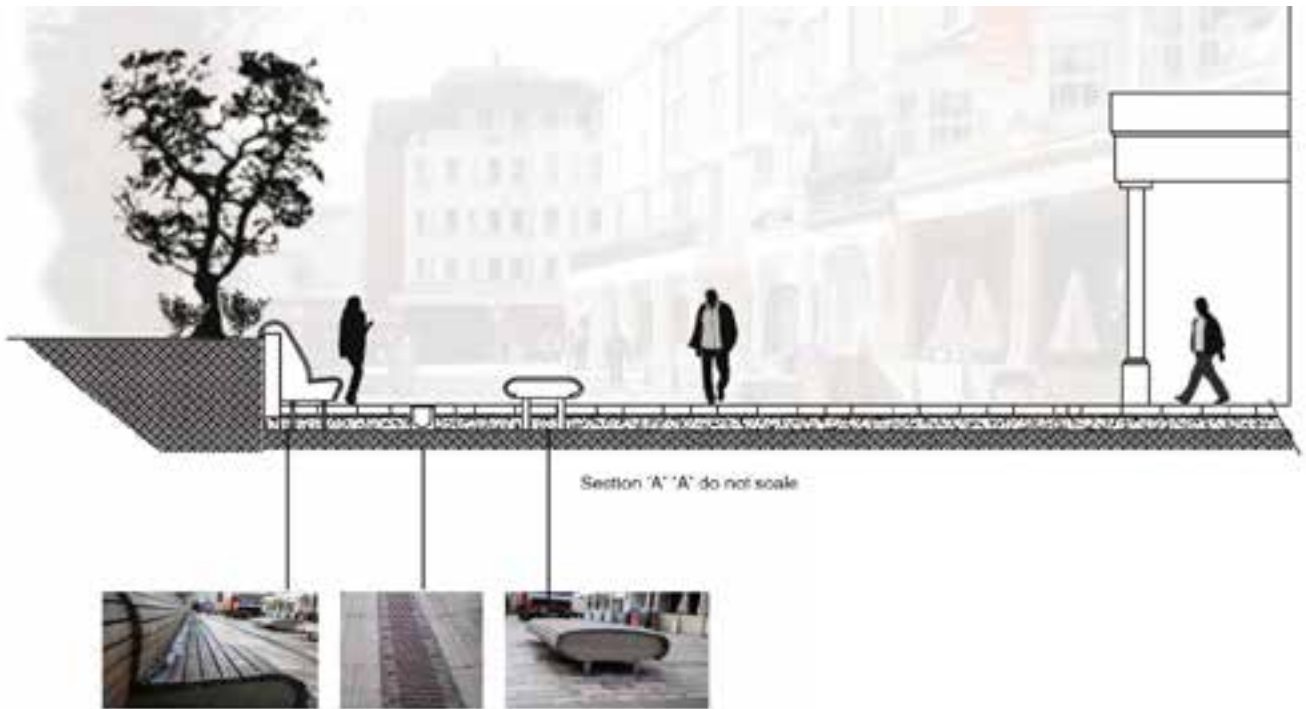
Proyecto New Road, Gehl Architects
